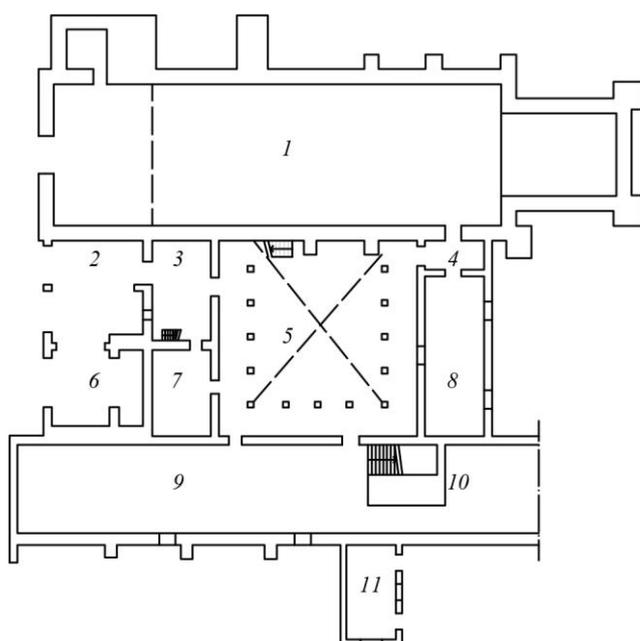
Esquema de la planta baja del convento de San Andrés Calpan. (Basado en el levantamiento realizado por F. Huerta Castillo que se conserva en el AGJE).
